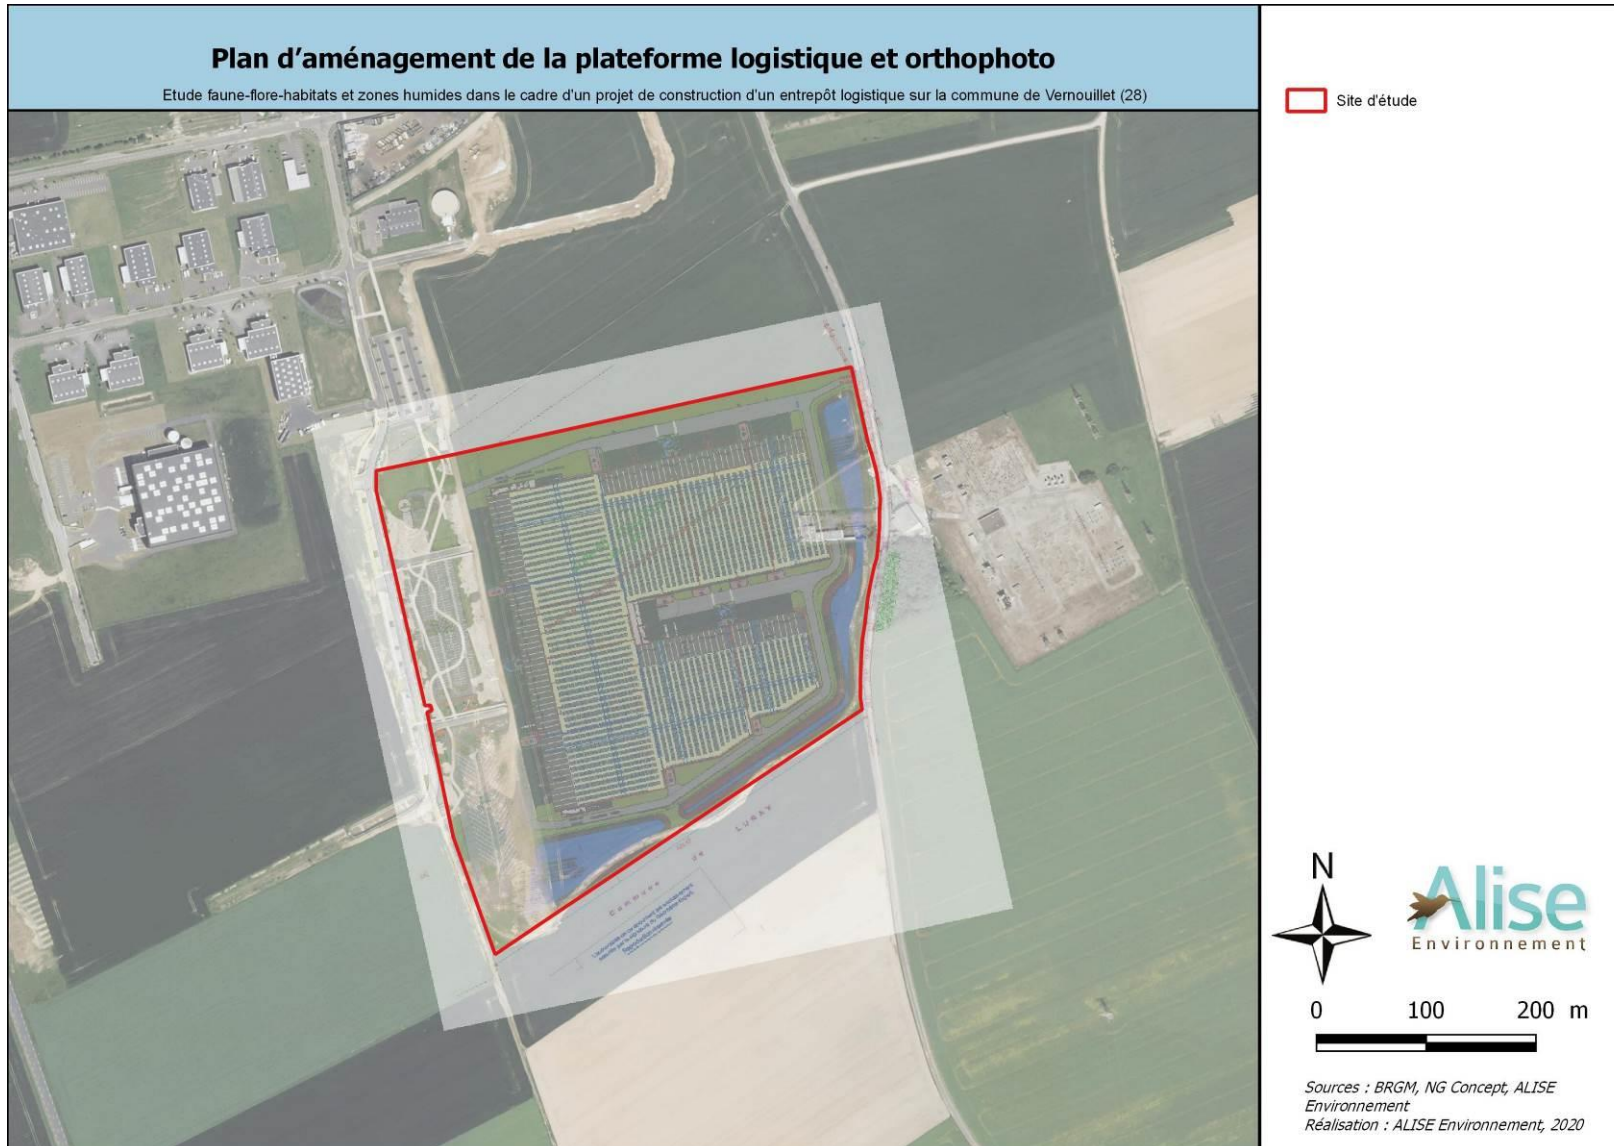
Plan d'aménagement de la plateforme logistique et orthophoto
